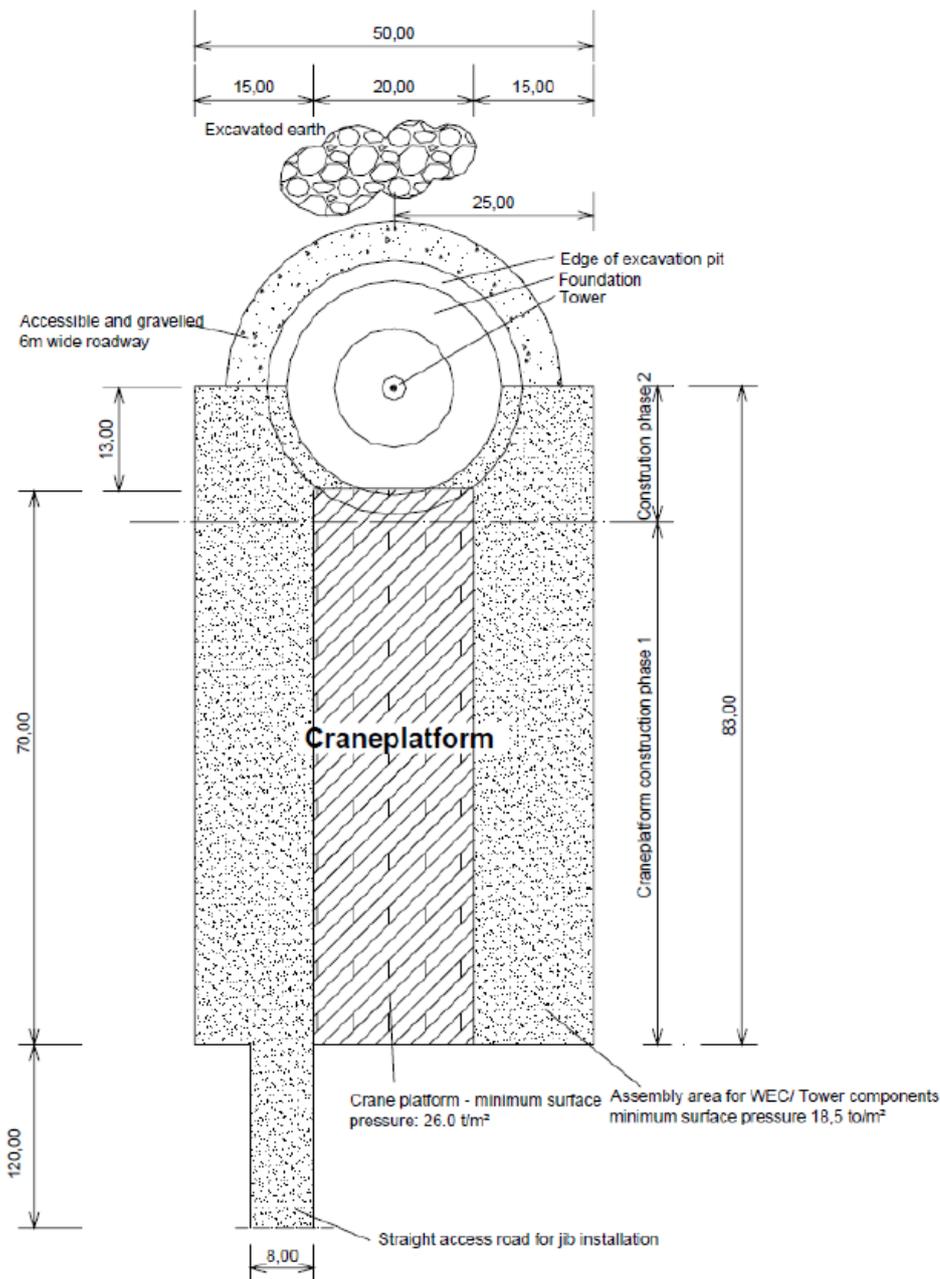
Disposizione delle gru rispetto alle fondazioni ed all'autoarticolato
